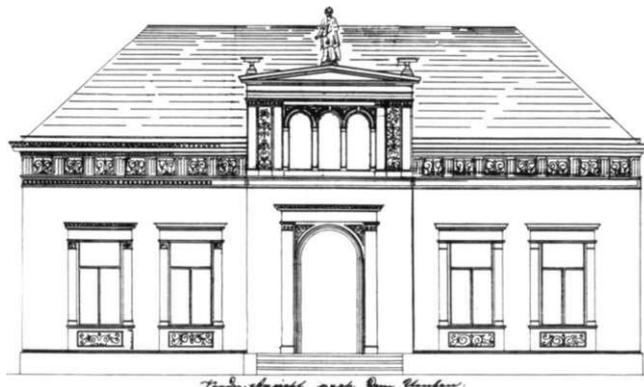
Schönebecker Straße 11-13, Fassadenaufriß aus dem Jahr 1871
